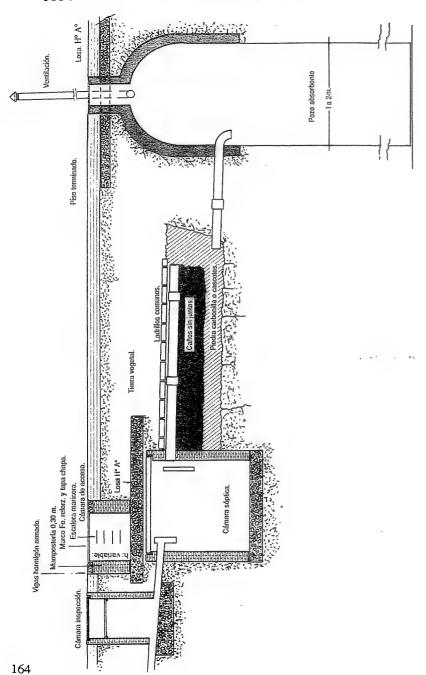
VI. Pozo absorbente y zanja drenaje.
